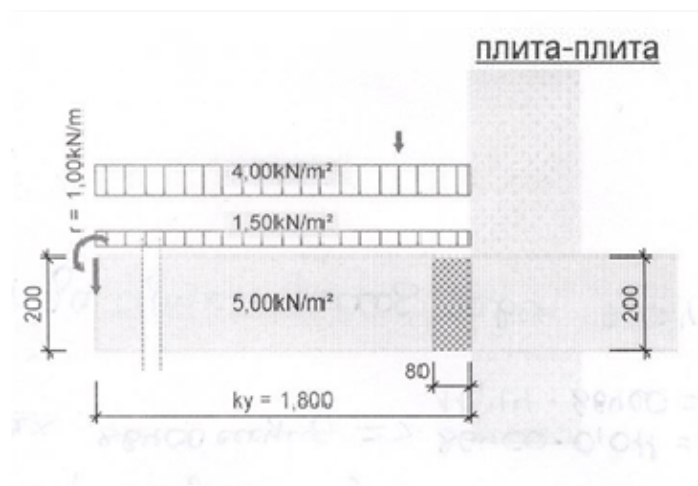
Схема расчетных нагрузок на элементы балконной плиты и теплоизоляционный элемент isokorb®.
